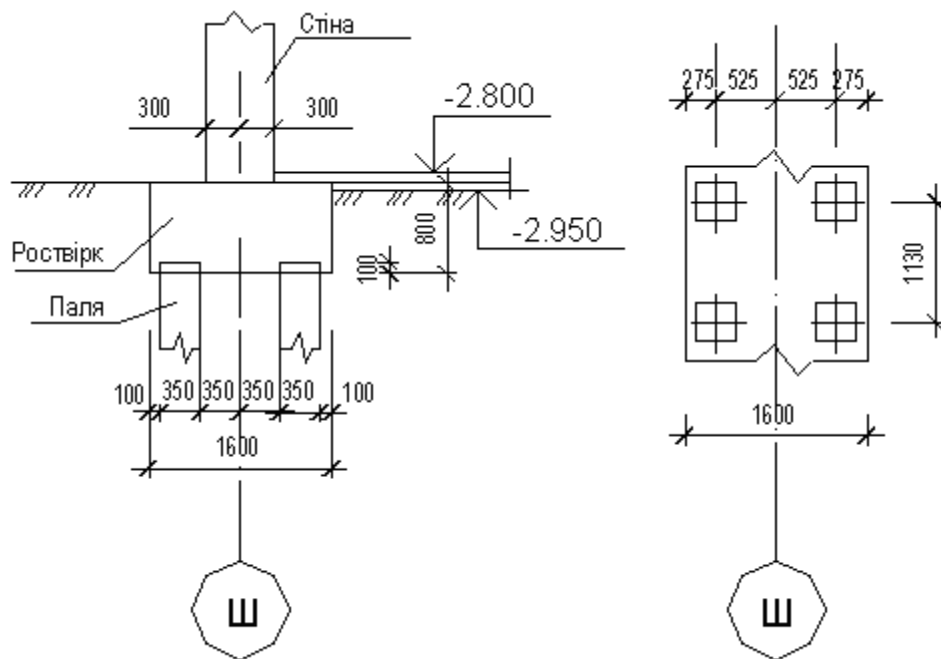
Конструкція пального фундаменту по вісі Ш
